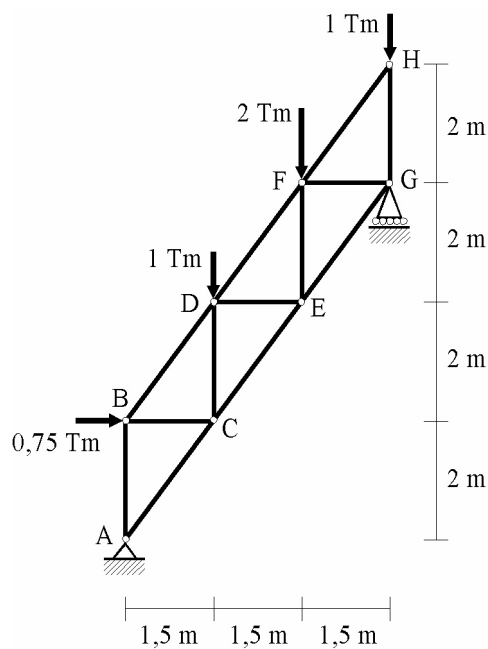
Estructura reticulada plana de l'exercici 2.12
